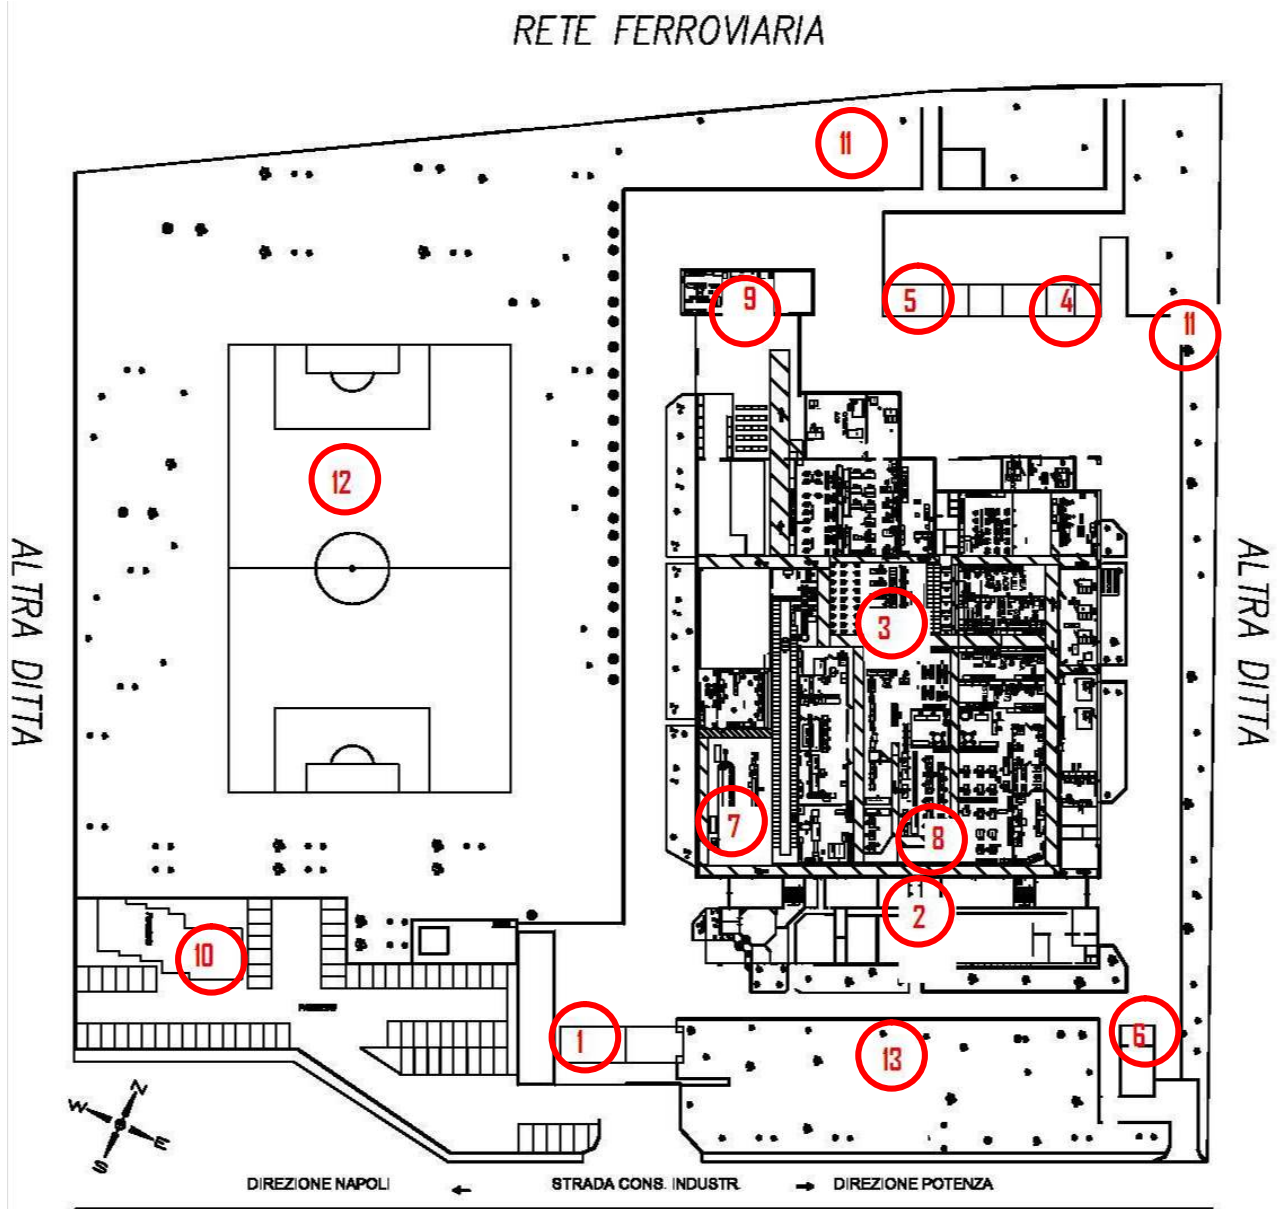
Planimetria dello stabilimento di Tito Scalo.
